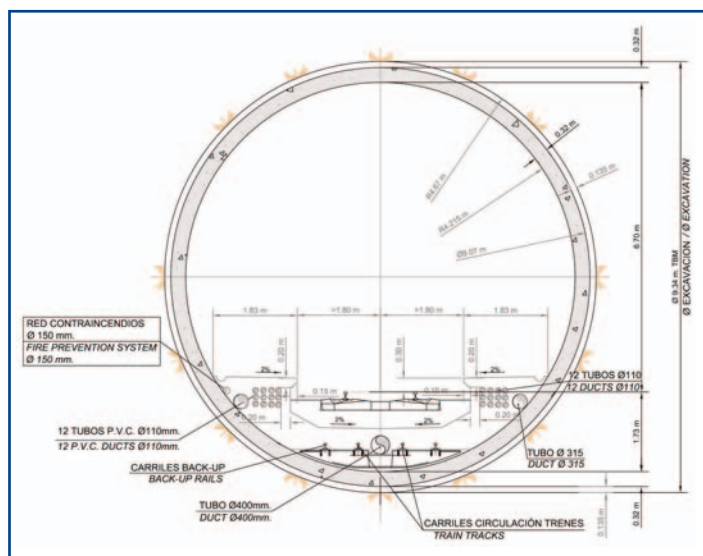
Sección tipo del túnel/Standard tunnel cross-section.
